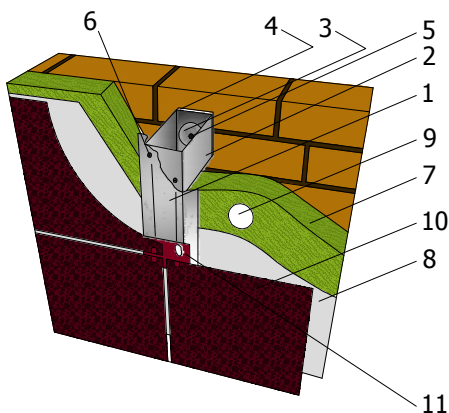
Конструктивное решение вентилируемого фасада «РУСЭКСР»:
